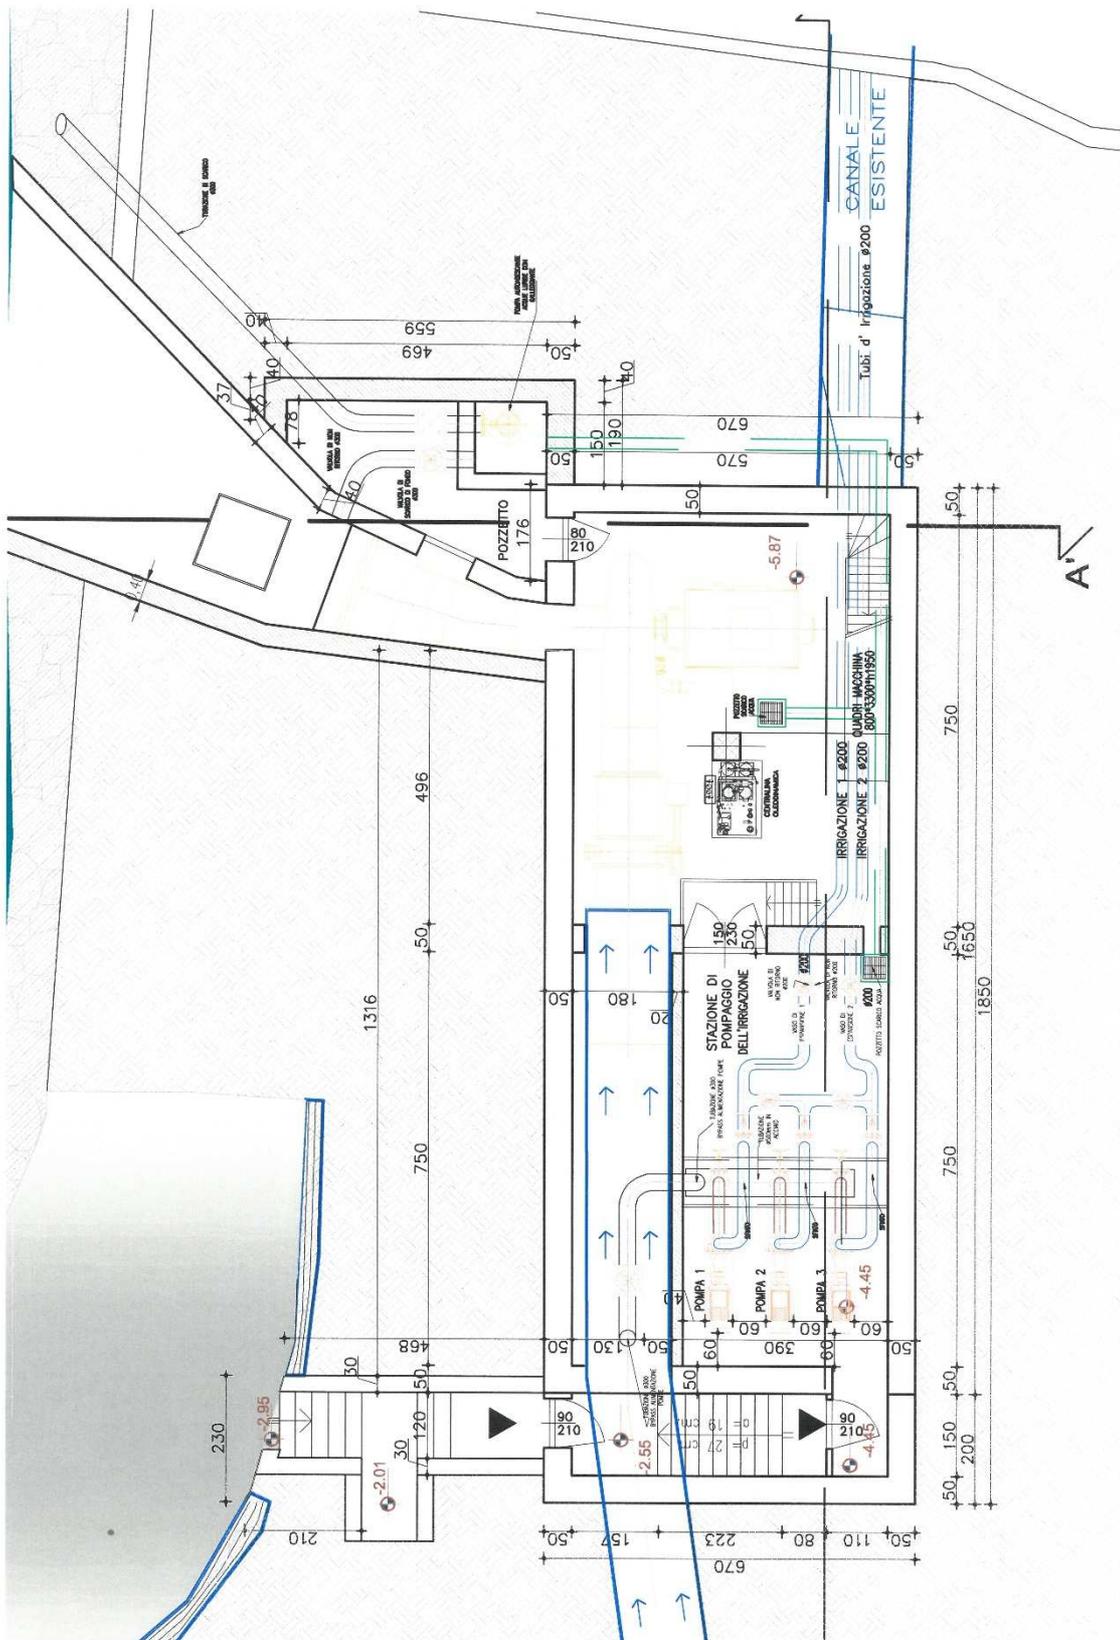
Pianta piano interrato fabbricato centrale nel progetto autorizzato
